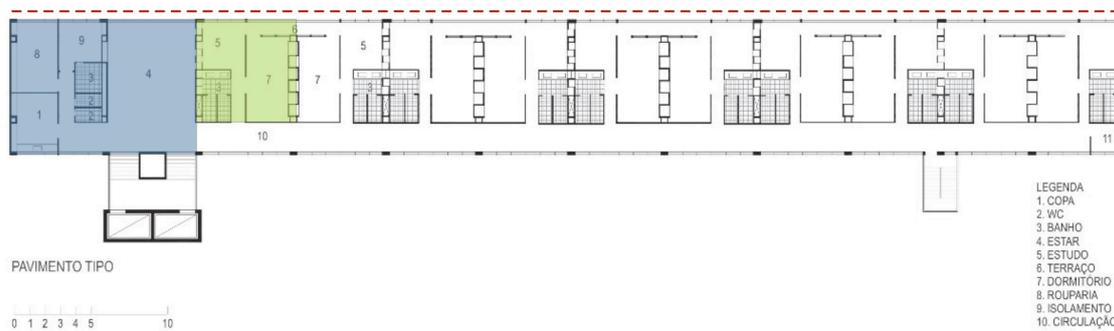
Planta baixa pavimento tipo, projeto original. Em azul a área de uso comum, em verde a célula residencial autônoma. A linha vermelha indica o plano de contato com a área verde. Fonte: REGINO, 2006.
